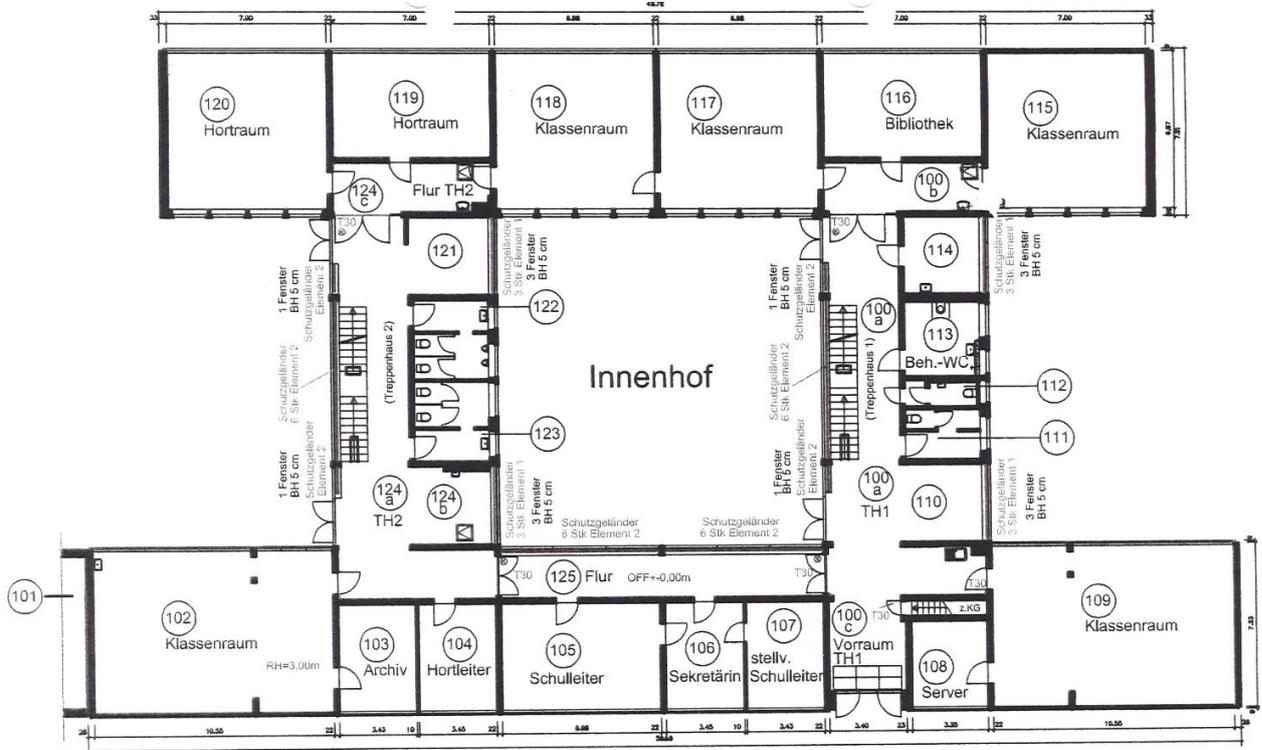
1. Bauabschnitt, Erdgeschoß Schulgebäude
